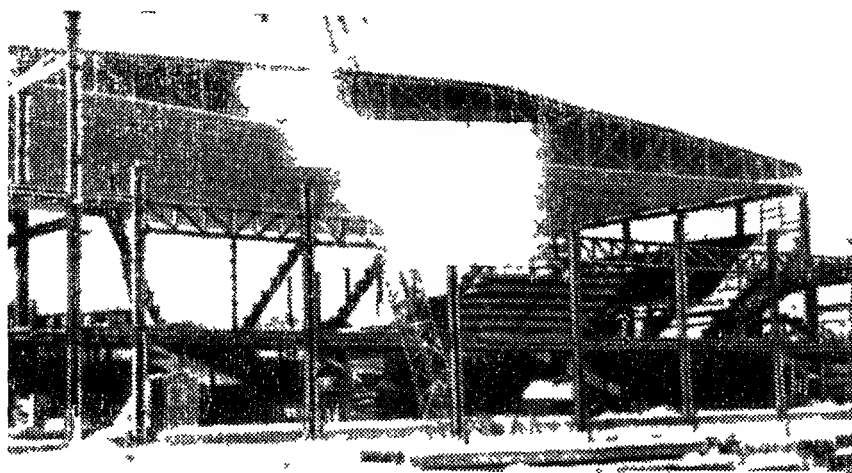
Объемно-блочная конструкция покрытия в процессе монтажа
